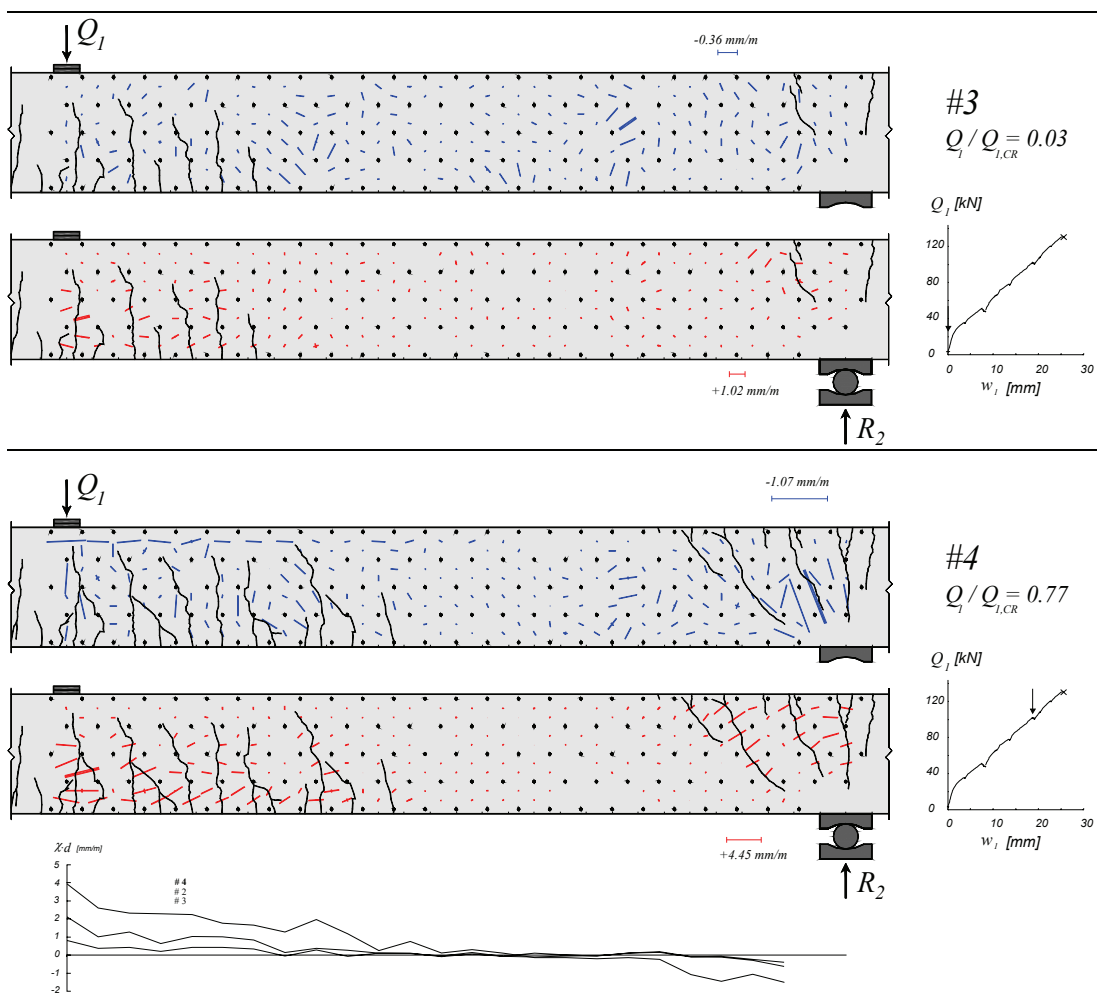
Poutre SR11: déformations principales, fissuration et courbures
